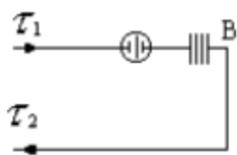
Схема № 25 - Потребитель с вентиляционной нагрузкой
